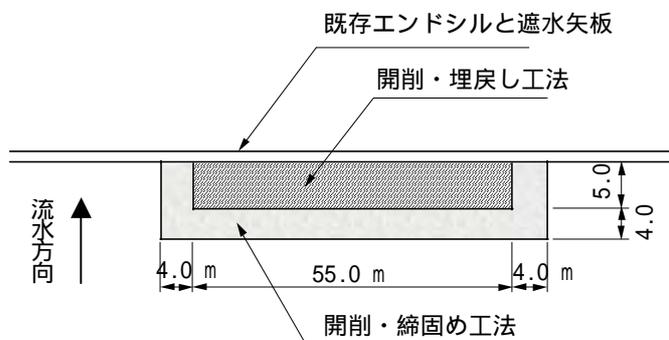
水叩き下部地盤の空洞部及びゆるみ地盤の処理範囲
